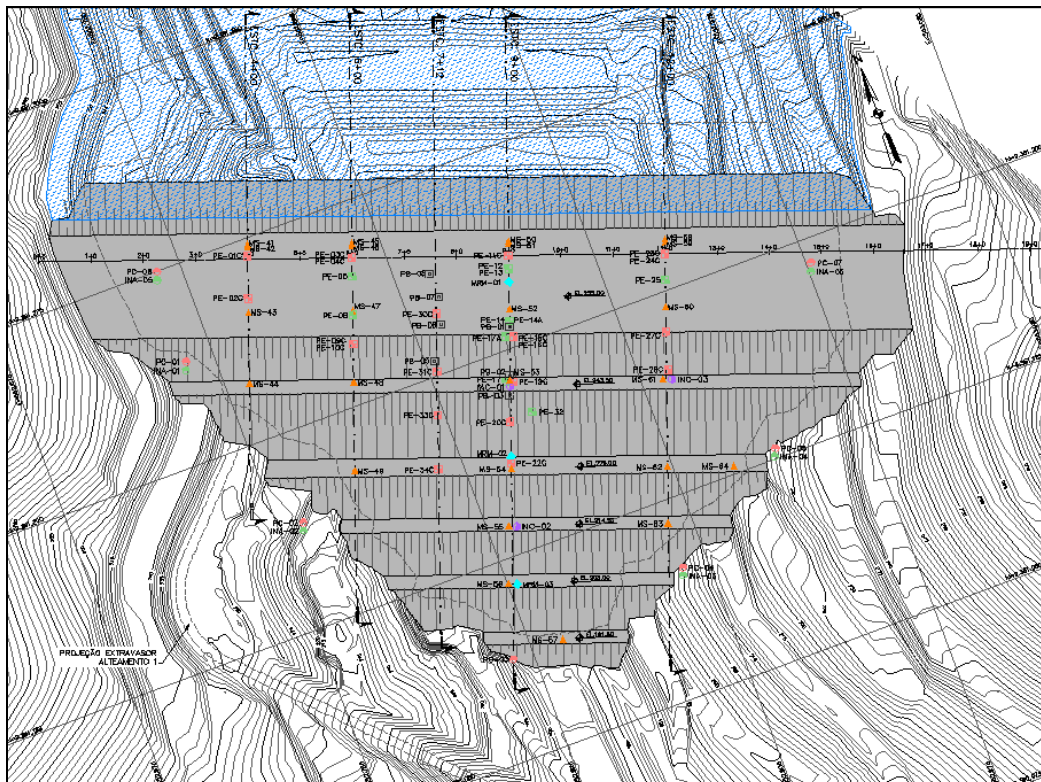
Planta de Localização das Seções de Análise – EL. 255 m
